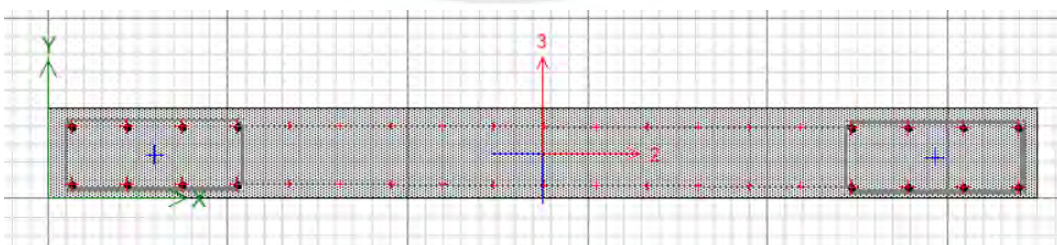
Distribución de acero prevista para la placa PL-01, segunda propuesta de reforzamiento
